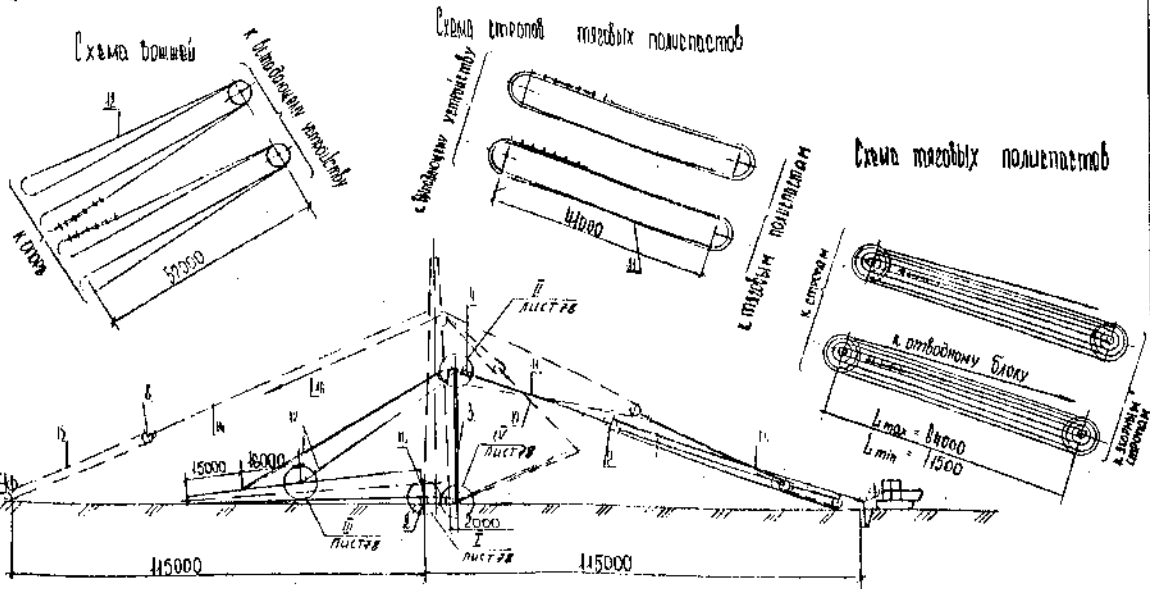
16. Схема подвеса опоры ГТТ 220-2/40
